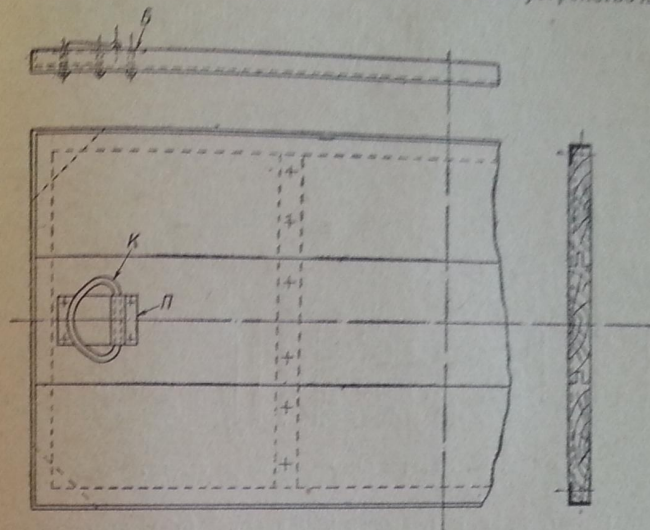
Крышка люка: К — кольцо люка, П — металлическая планка для крепления кольца и крышки люка, Б — болты, крепящие планку.
